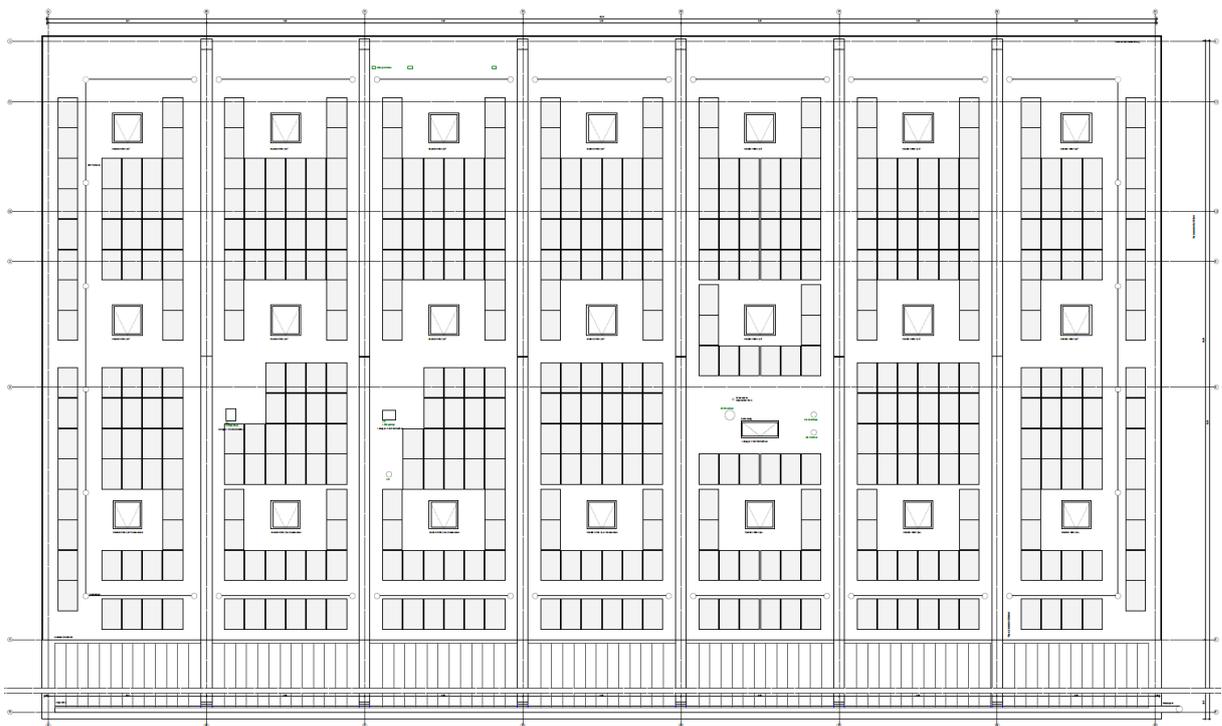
Dachfläche mit maximaler Bestückung mit 462 PV-Modulen
